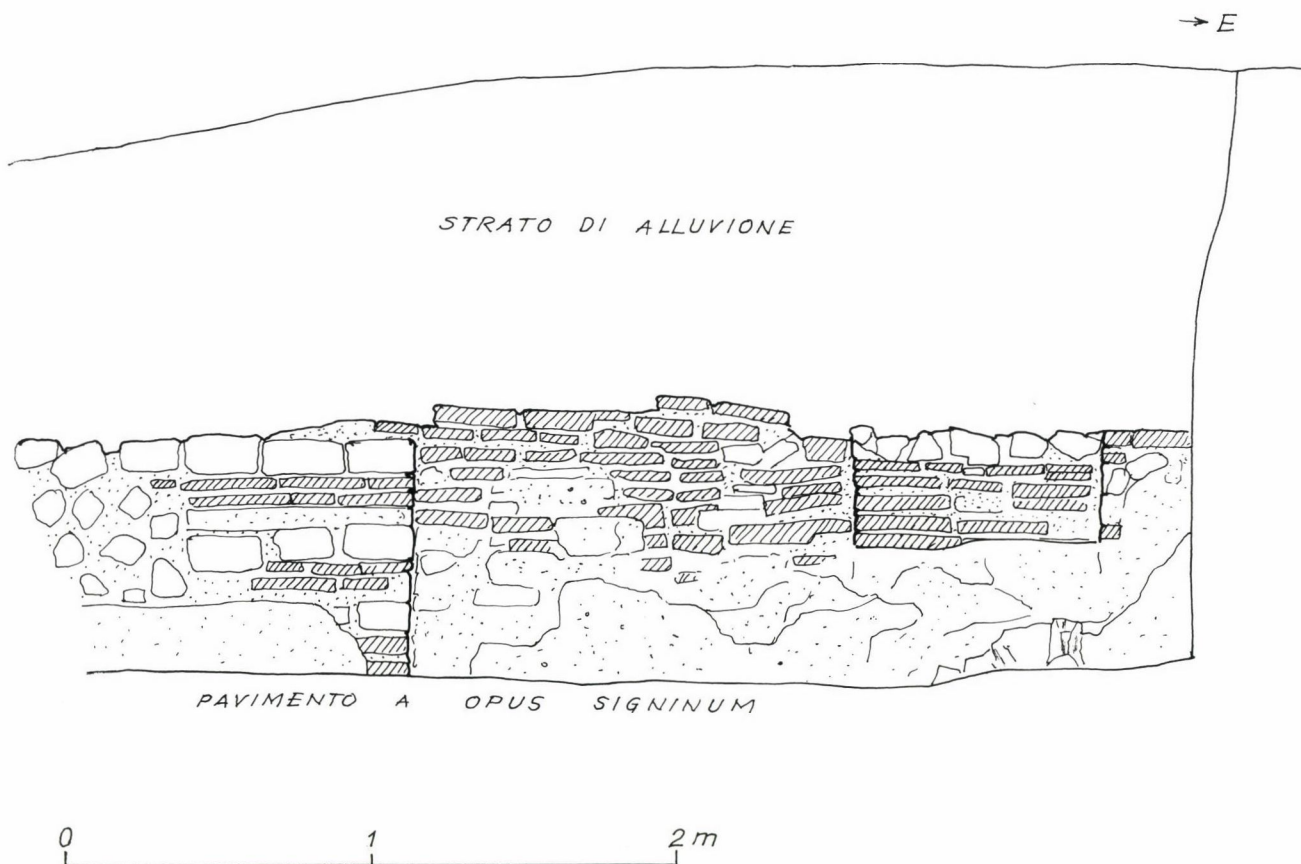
Ambiente VIII. Struttura muraria del muro settentrionale del vano con pavimento a opus signinum
